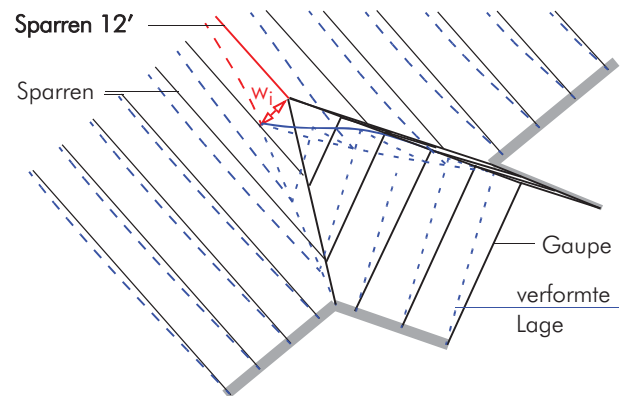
F.15 Darstellung des räumlichen Stabwerkmodells des Dachwerks inklusive Dachlattung mit Verformungen.
